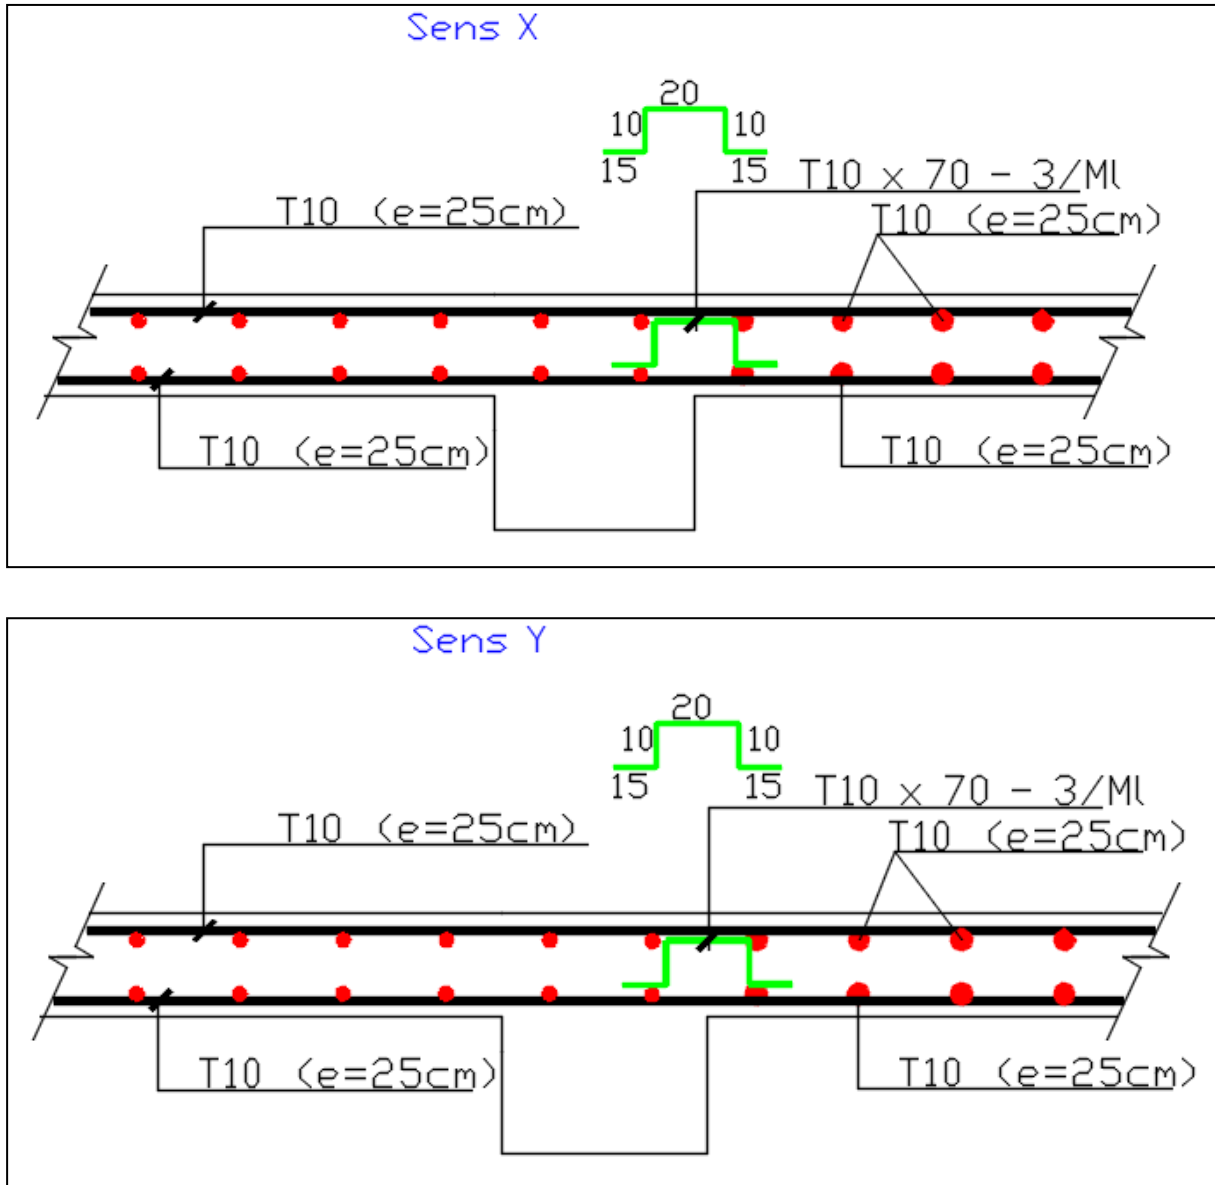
Dessin de ferrailage de la dalle pleine.
